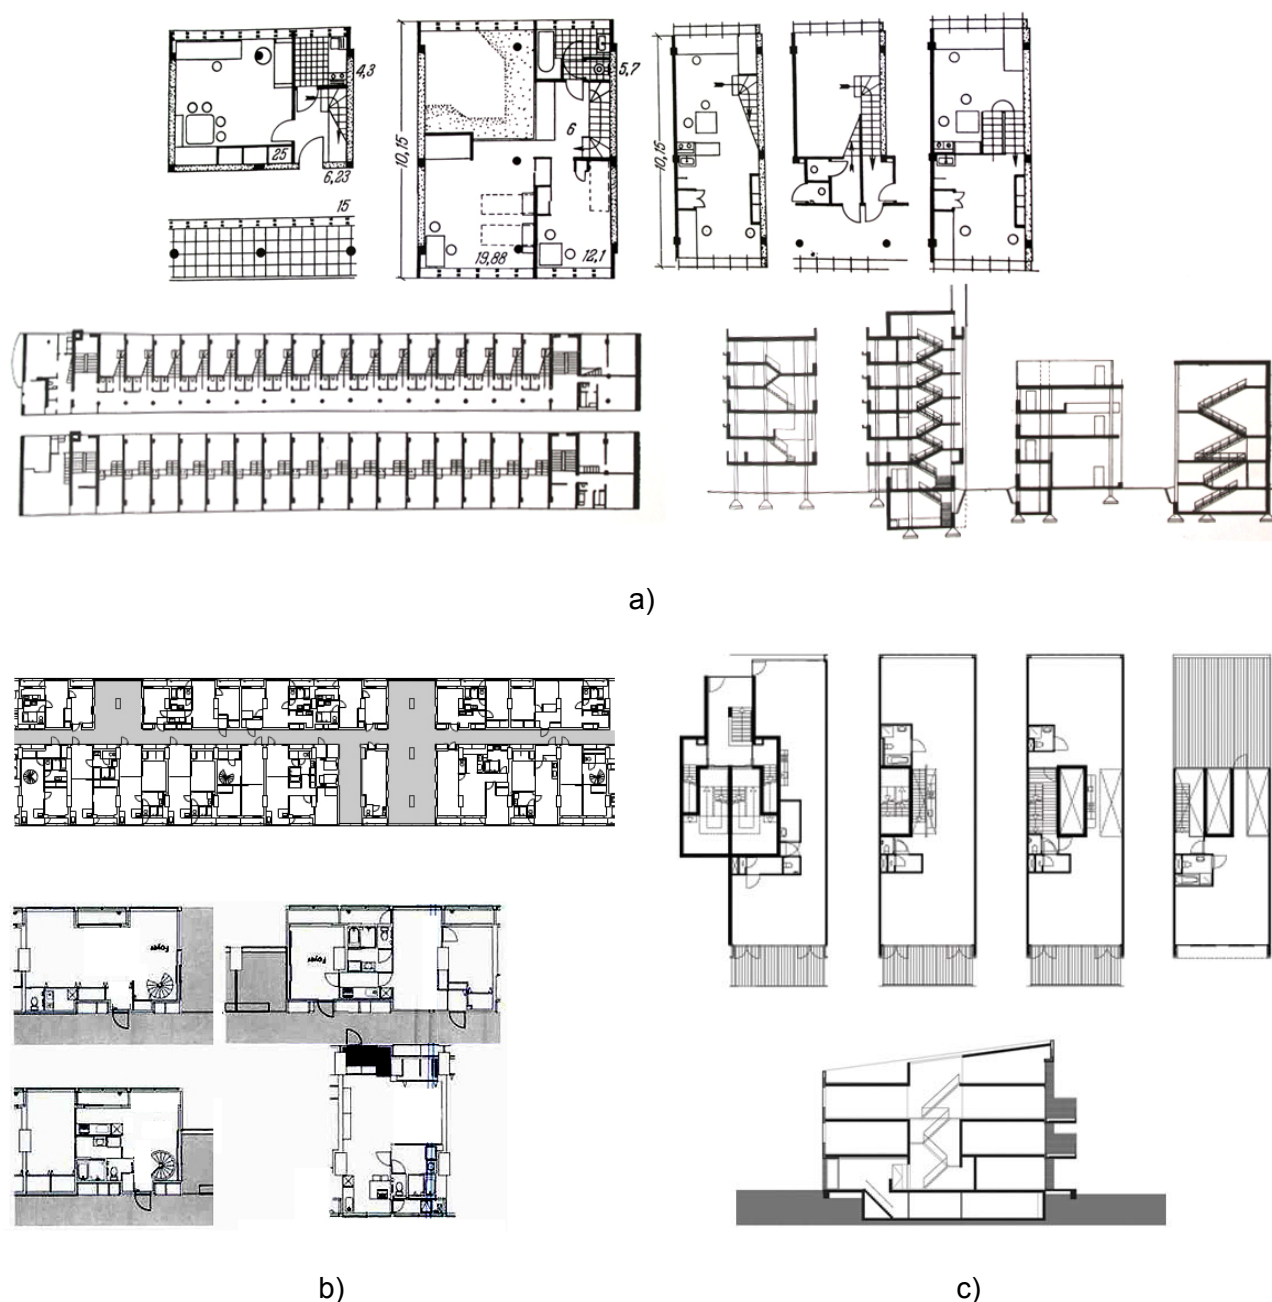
(а-с): а) Дом Наркомфина, арх. М. Гинзбург, И. Милинс (Москва, Россия) (вверху – планы жилых ячеек, внизу – план жилого блока и разрезы); б) Shinonome Canal Court, арх. Yamamoto & Field Shop (Токио, Япония) (вверху – план типового этажа, внизу – планы жилых модулей); в) Ijburg block 4, арх. Maccreanor Lavington (Амстердам, Нидерланды) (вверху – план жилых модулей, внизу – схема разреза)
